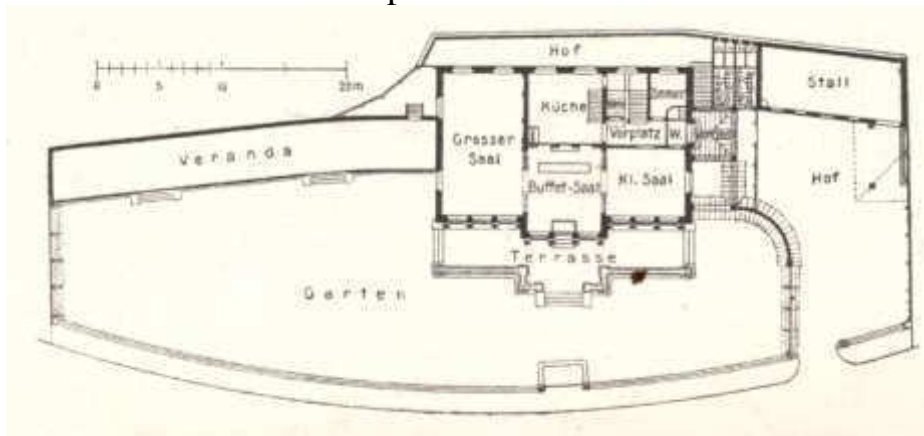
Grundriss Duwe's Elbpavillon 1878/1879.
